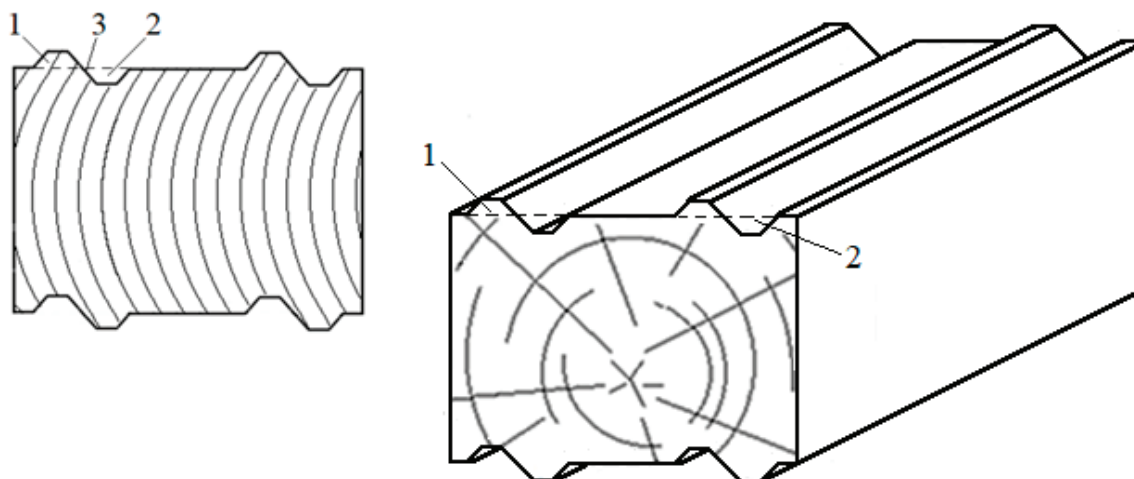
Инновационный строительный профилированный брус в схематичном поперечном сечении с фигурным профилем. 1 — опорный выступ; 2 — установочный паз; 3 — опорная поверхность
